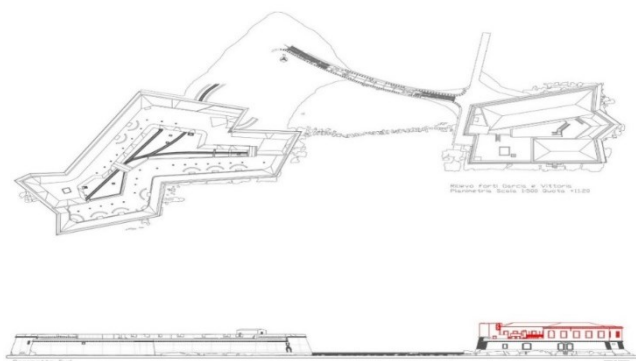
Pianta piano copertura e prospetti sud dei forti Garcia (a sinistra) e Vittoria (a destra). La parte disegnata in rosso indica la sopraelevazione risalente al XIX secolo. Rilievi dell'autore
